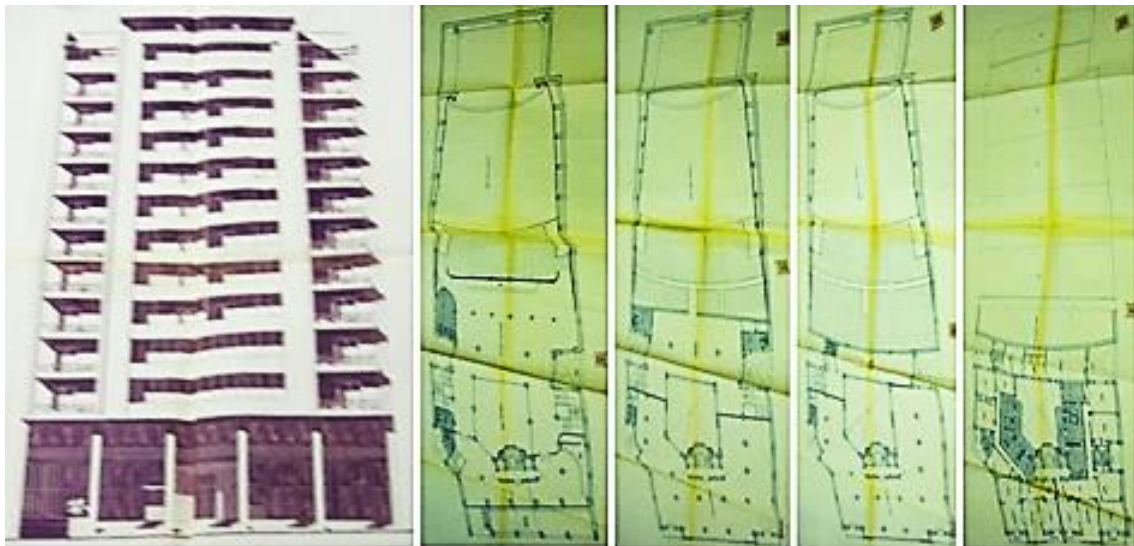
Planos del Cine Coliseum de Cáceres: alzado, entresuelo, planta primera, segunda y viviendas (HURTADO COLLAR, F., 1960).
